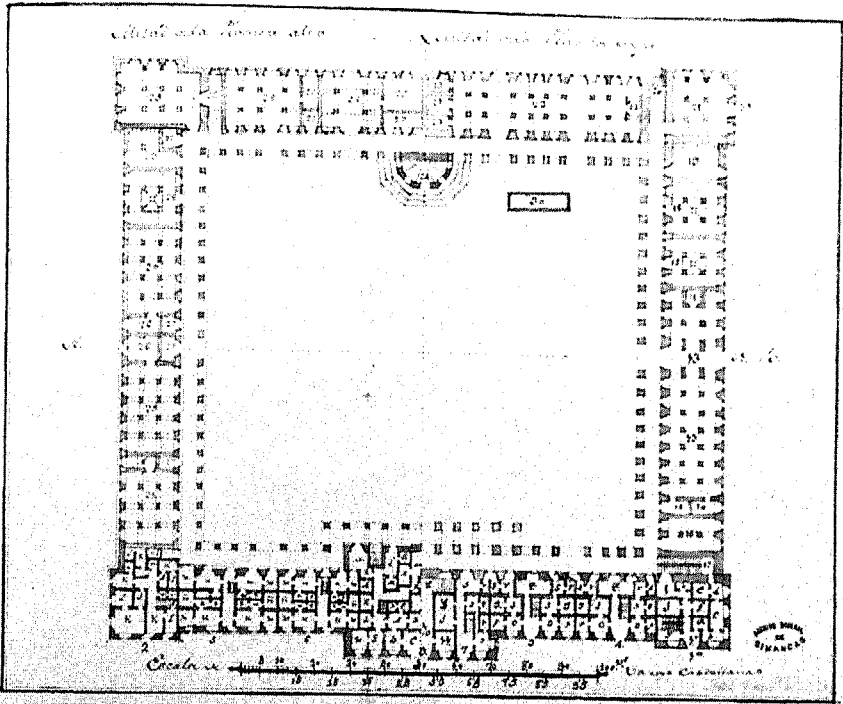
Primera propuesta de Cuartel de Caballería realizada por Caraza con mitad de la planta alta y mitad de la planta baja. [A.G.S. M.P.D. XLVII-17]
